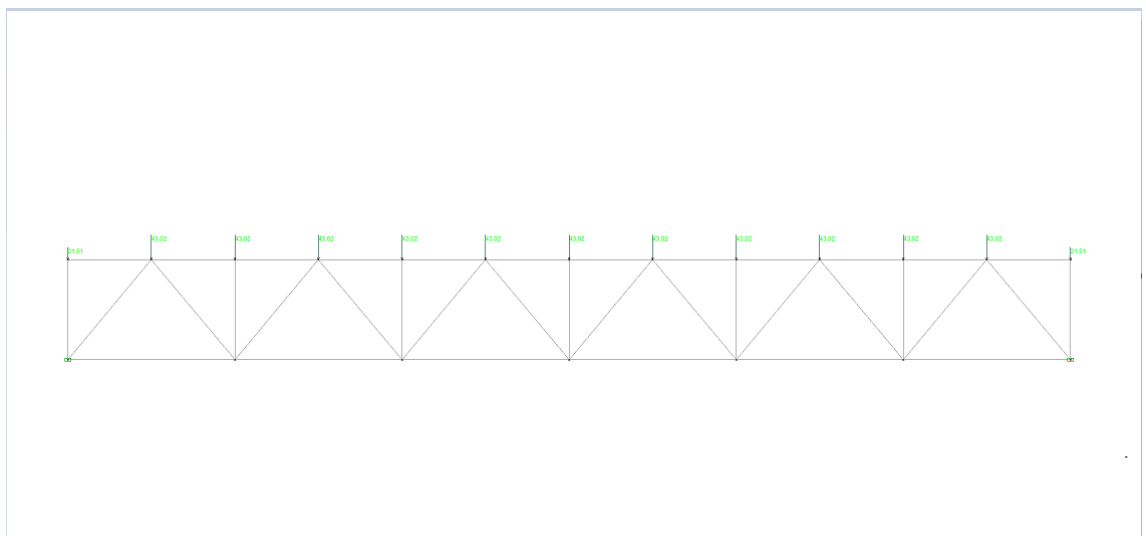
Схема навантаження у вузлах ферми прольотом 36 м
